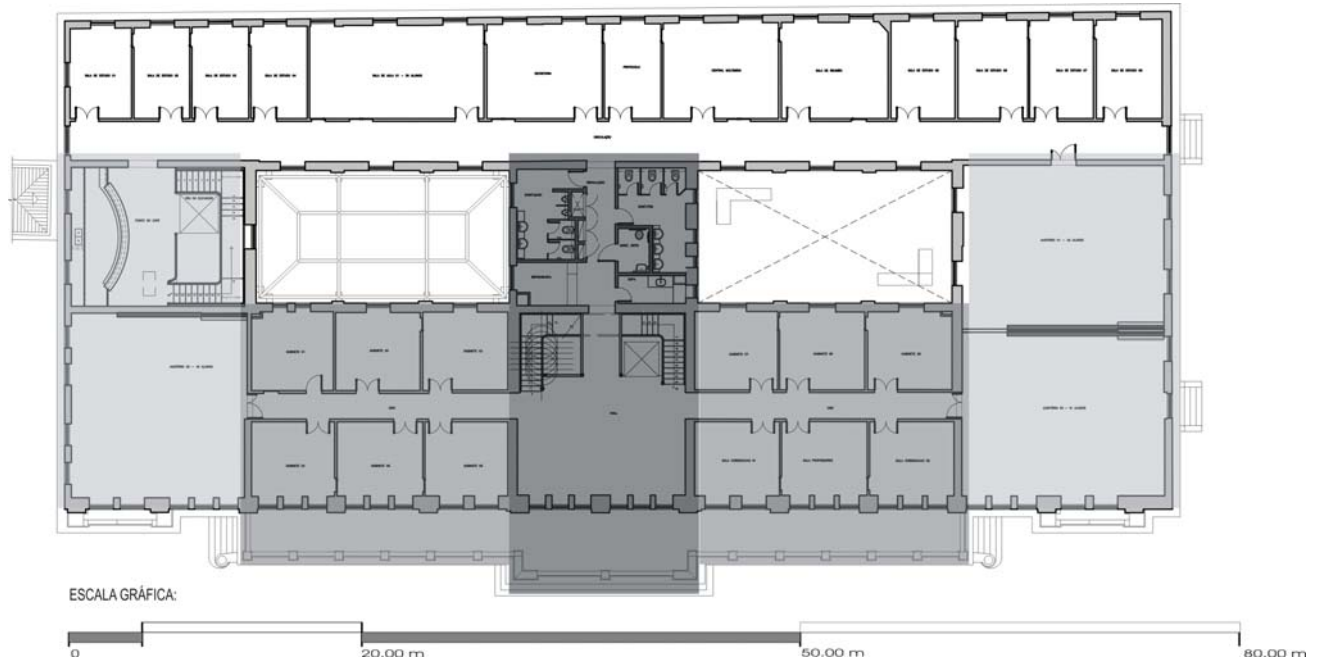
Relação Planta-Fachada – simetria terceiro pavimento.
